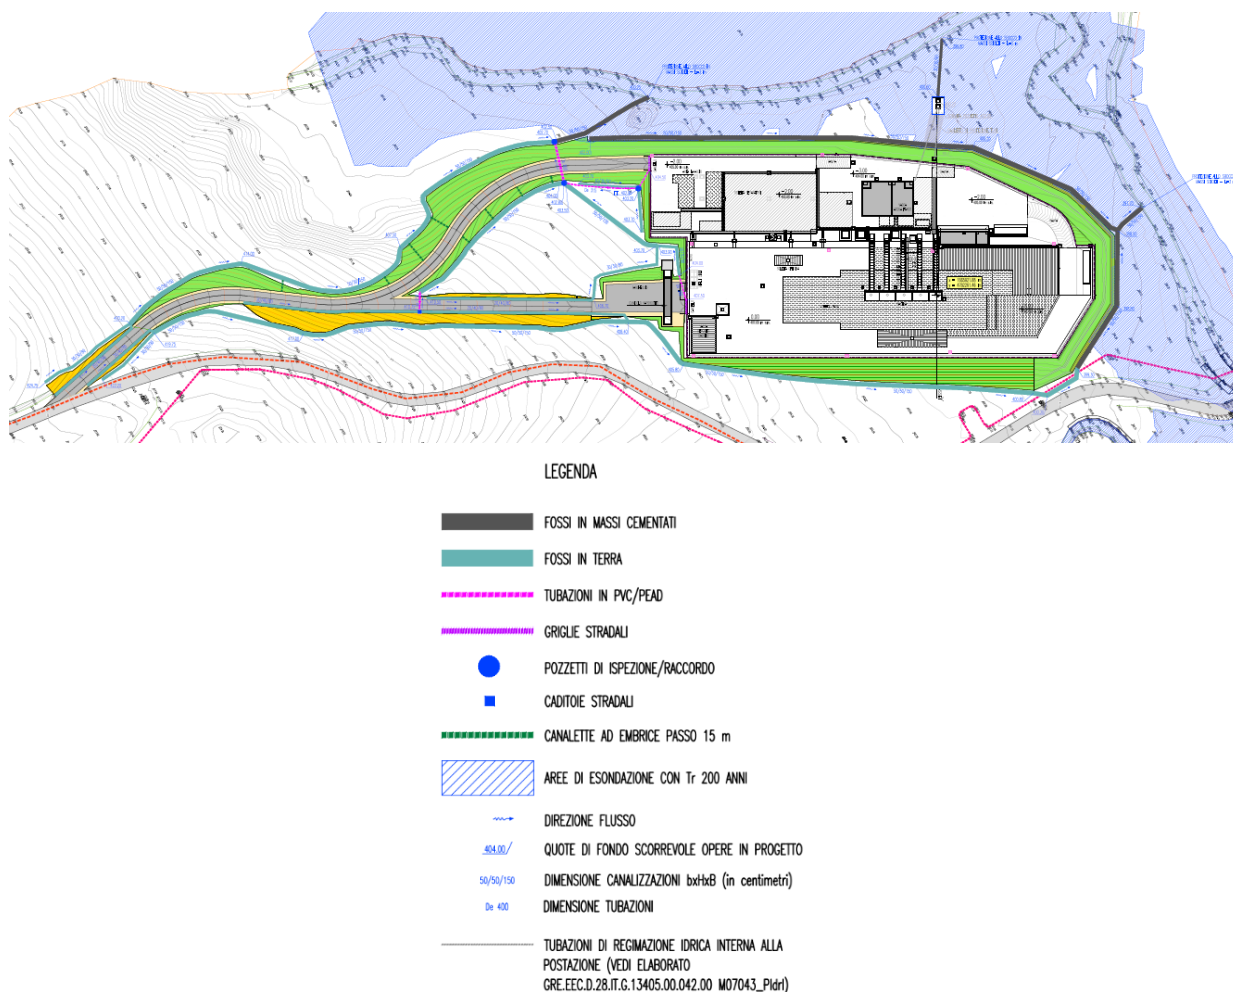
Planimetria di progetto della rete idraulica di intercettazione ed allontanamento delle acque esterne alla postazione.
